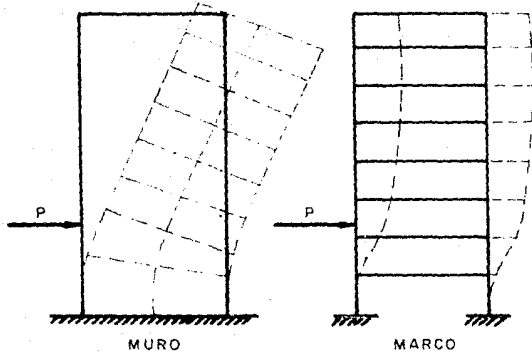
Comportamiento de muros y marco ante fuerzas horizontales.
